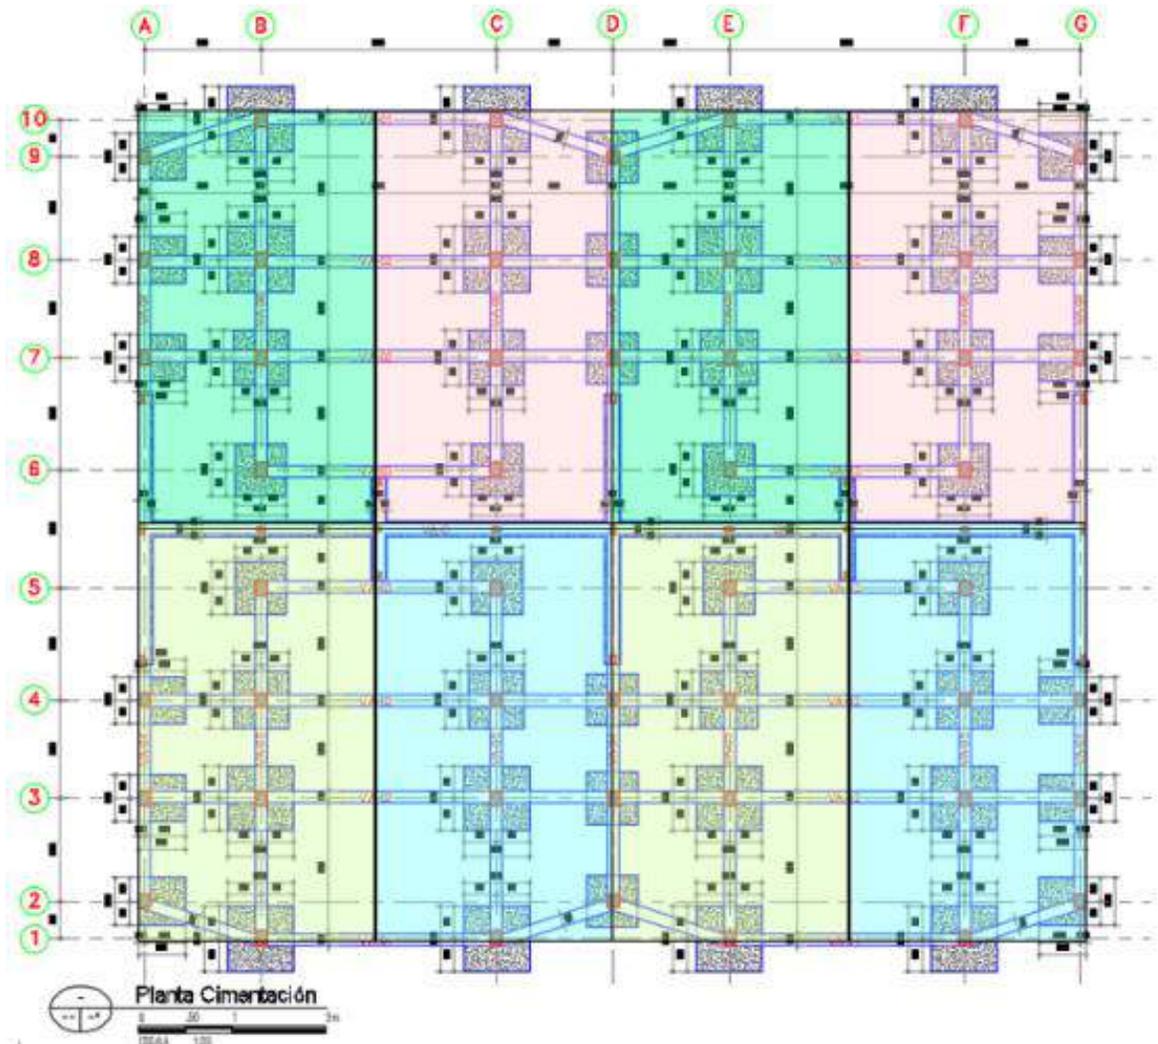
Planta de cimentación para 8 viviendas agrupadas - Según plano E1/05. Esta distribución estructural original de la agrupación, según la licencia de construcción aprobada, no corresponde a la disposición construida en forma lineal de una vivienda enseguida de la otra. Se aprecia que no existe cimiento para el muro de triple altura que separa las viviendas.
